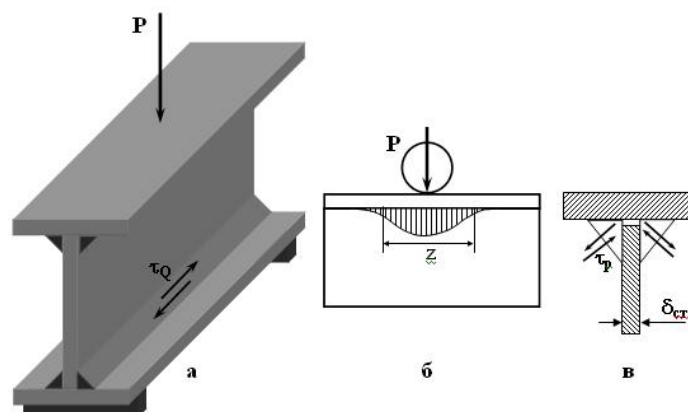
Схема расчета поясных швов сварных балок.
